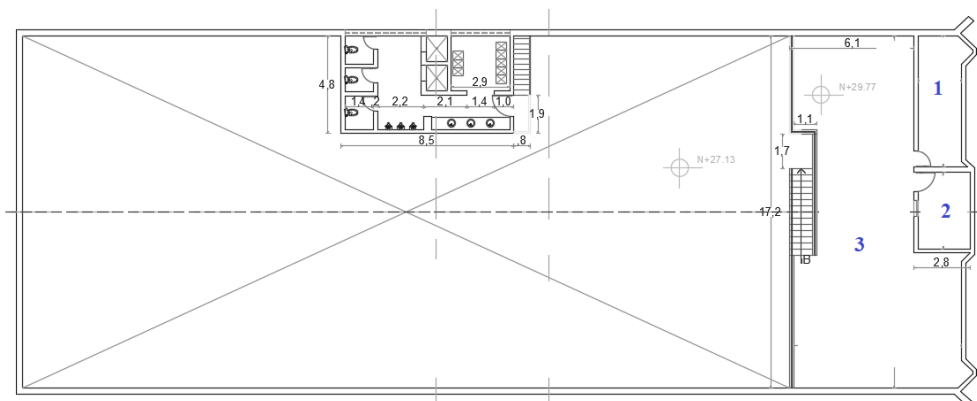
Área 3: Planta de almacenamiento (plana alta)
